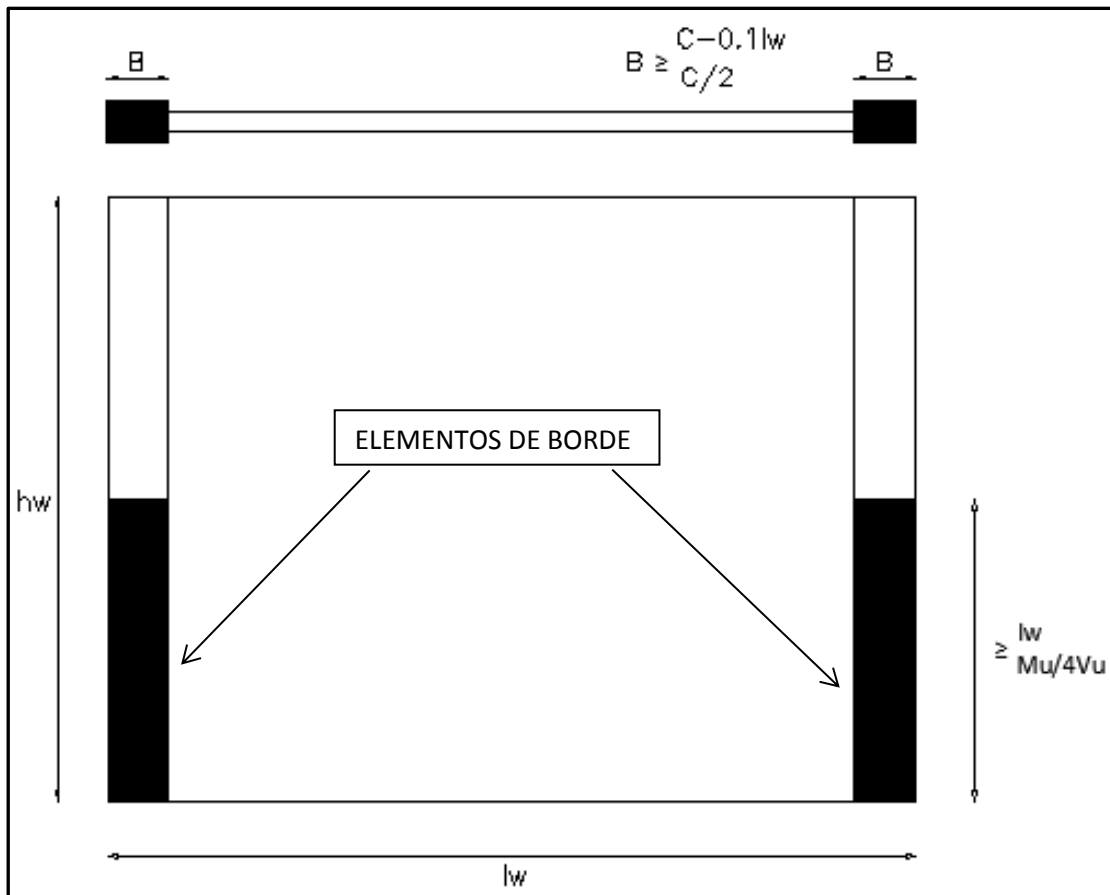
DIMENSIONAMIENTO DE MURO DE CORTE
